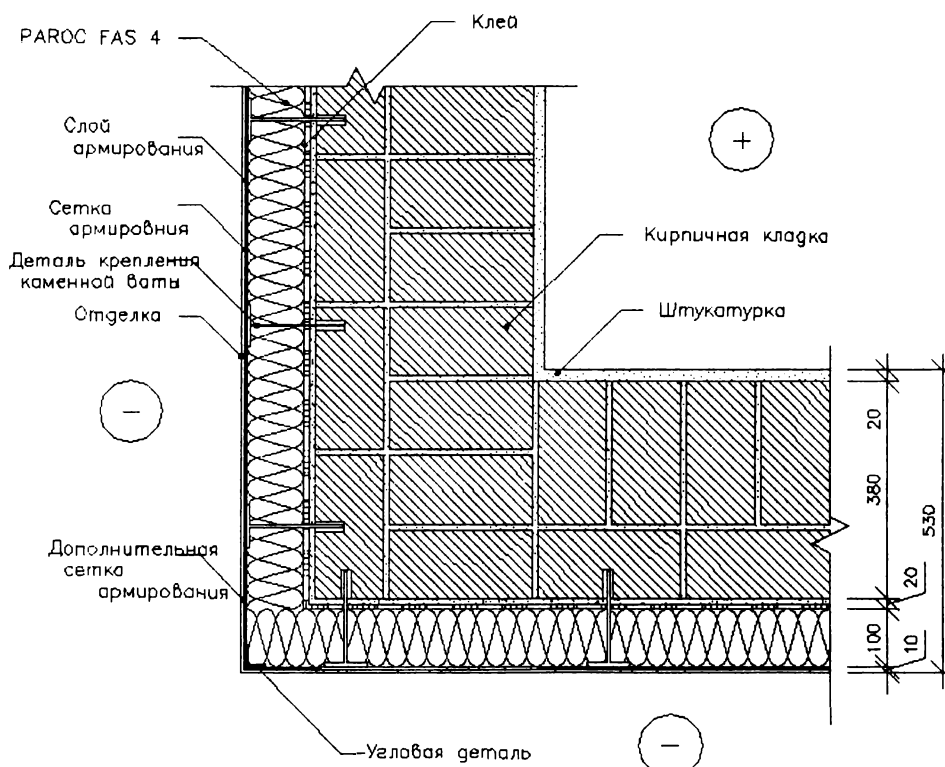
Утепление стены кирпичной кладки, применяя для системы плиту FAS 4
